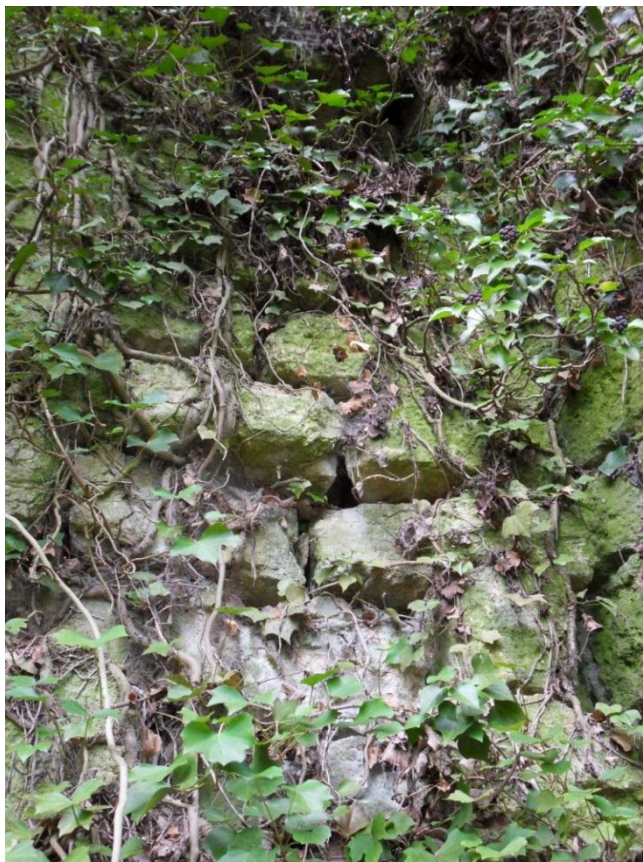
Gros plan sur le démantèlement du mur dans l'angle avec la Tour des Moines.
